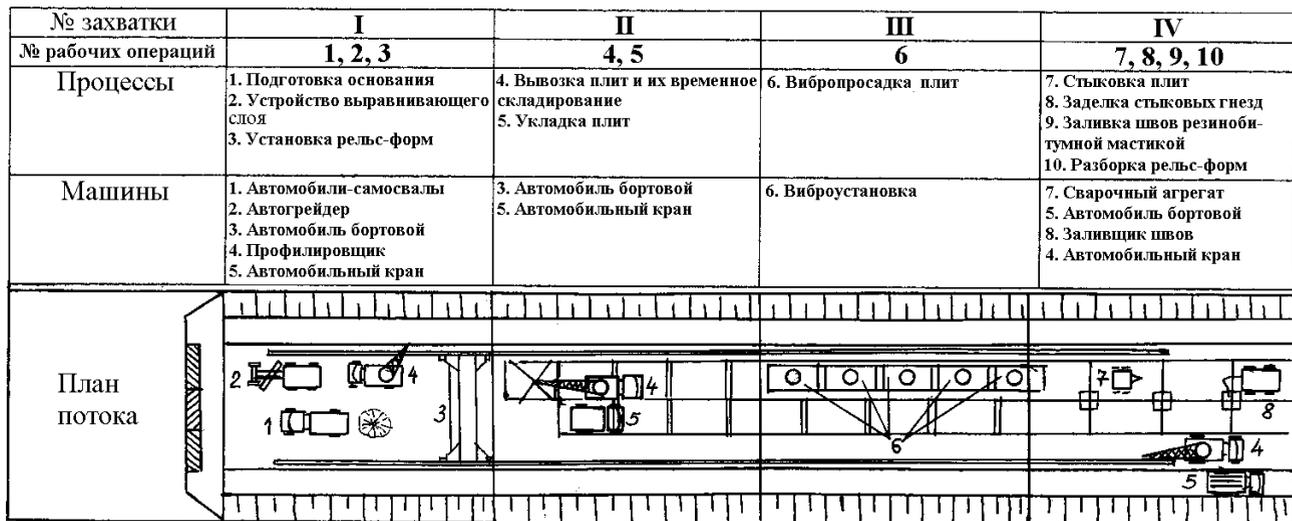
Технологическая схема производства работ по устройству сборного покрытия из железобетонных плит
